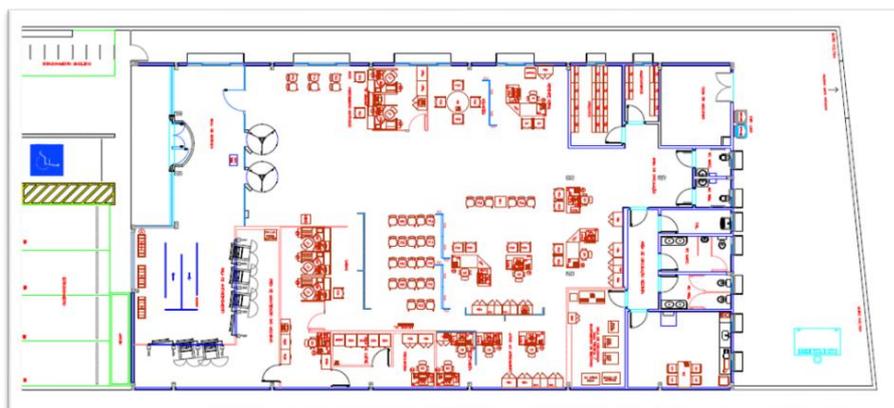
Planta baixa da agência bancária em Caçador/Sc.
